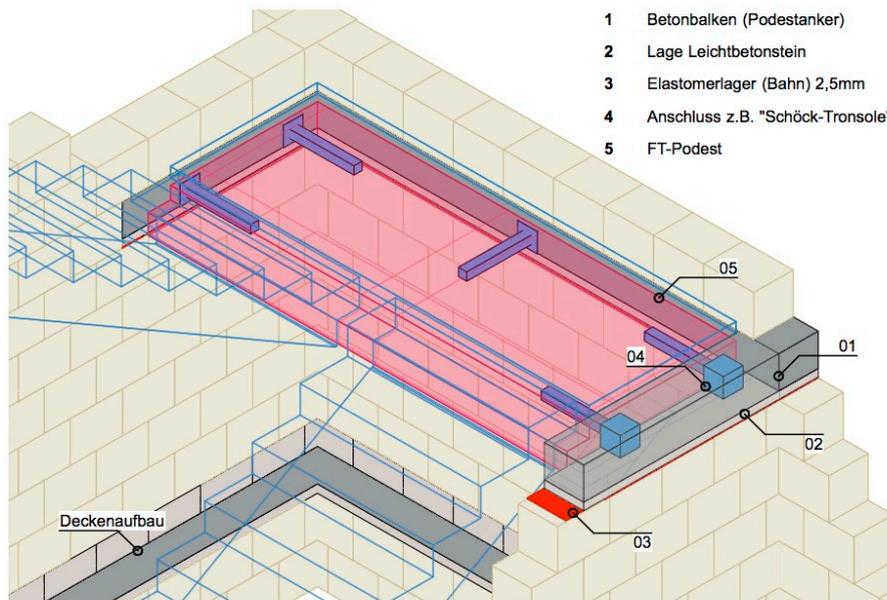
Einbausituation – Verankerung / Lagerung Treppenpodest
